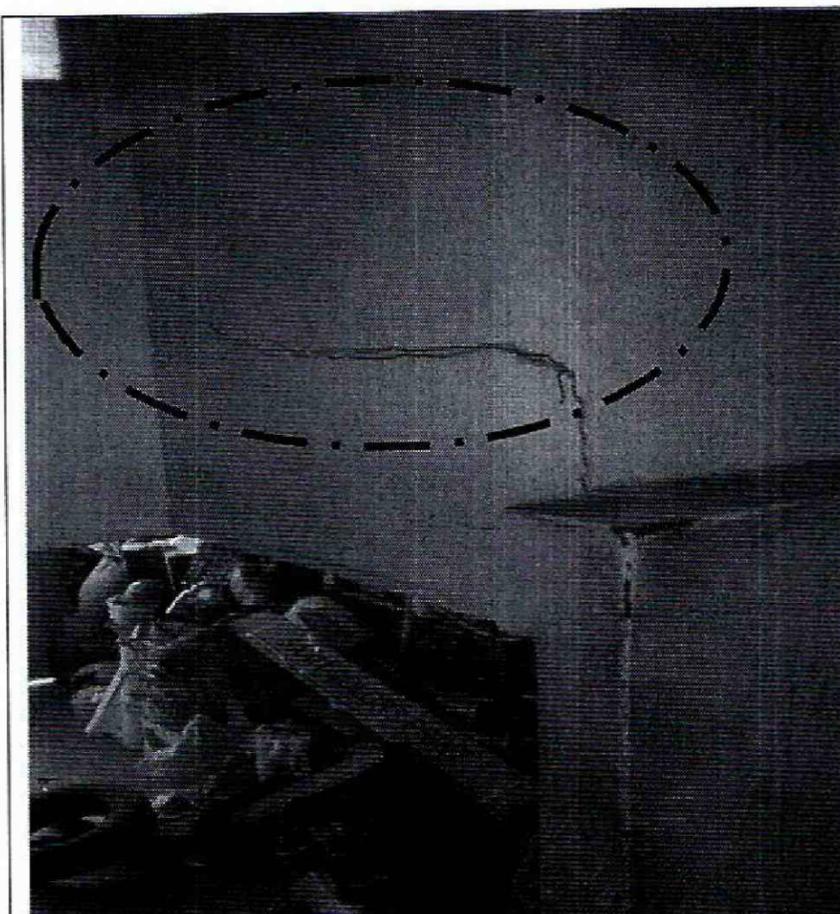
Fisuras identificadas en muros de cerramiento y divisorios en la vivienda de la Calle 137 A No 98 B - 21
